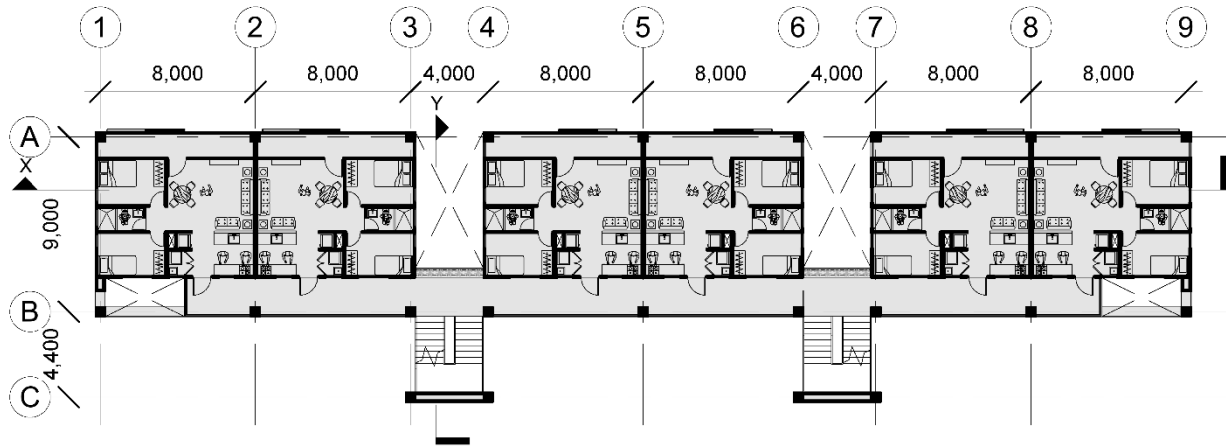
PLANTA ARQUITECTÓNICA EDIFICIO 3 | Elaborado por: El autor
